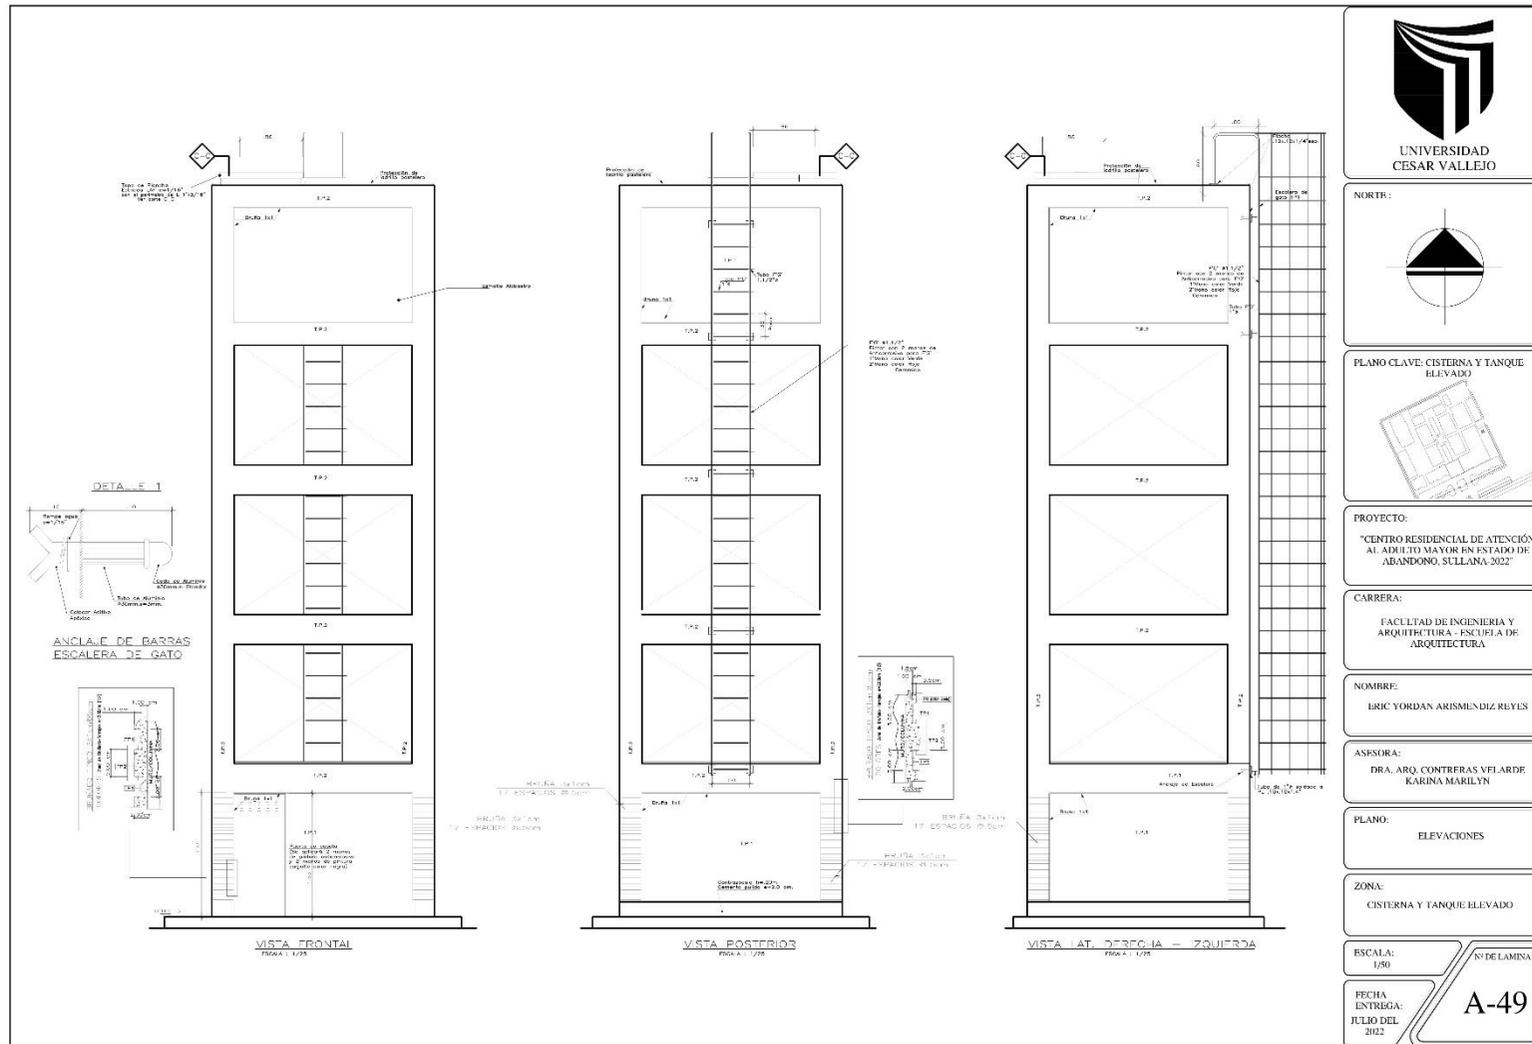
Plano de zona de cisterna y tanque elevado-elevaciones A – 49
